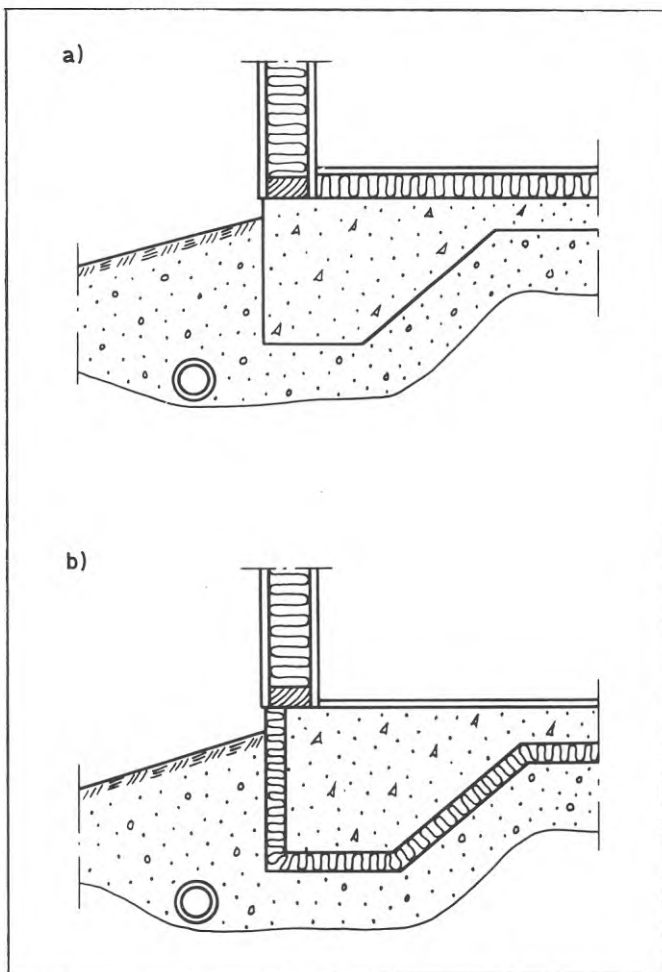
Principifigur utvisande alternativa placeringar av värmeisoleringen vid grundläggning med kantförstyvad betongplatta på mark.
